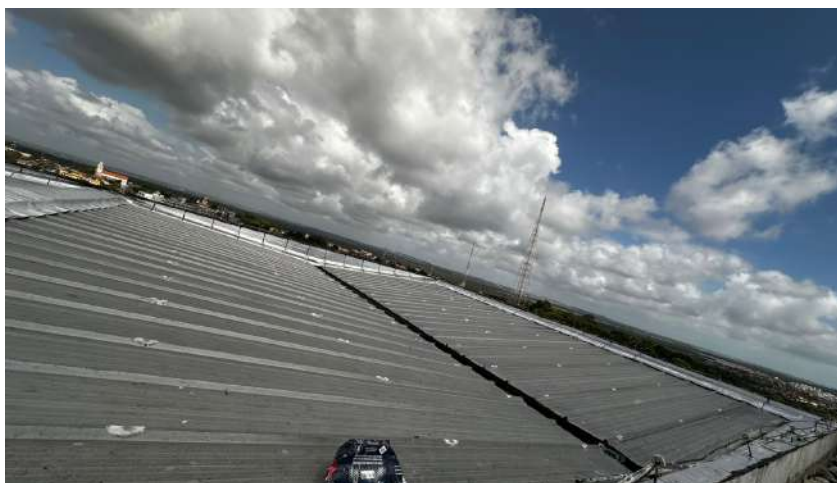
Laje da cobertura com telhas, ponto – 05.
